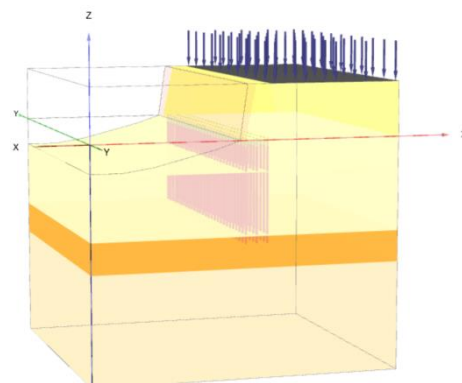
Расчетная схема устойчивости набережной р.Мойка на этапе утраты оголовков свай
